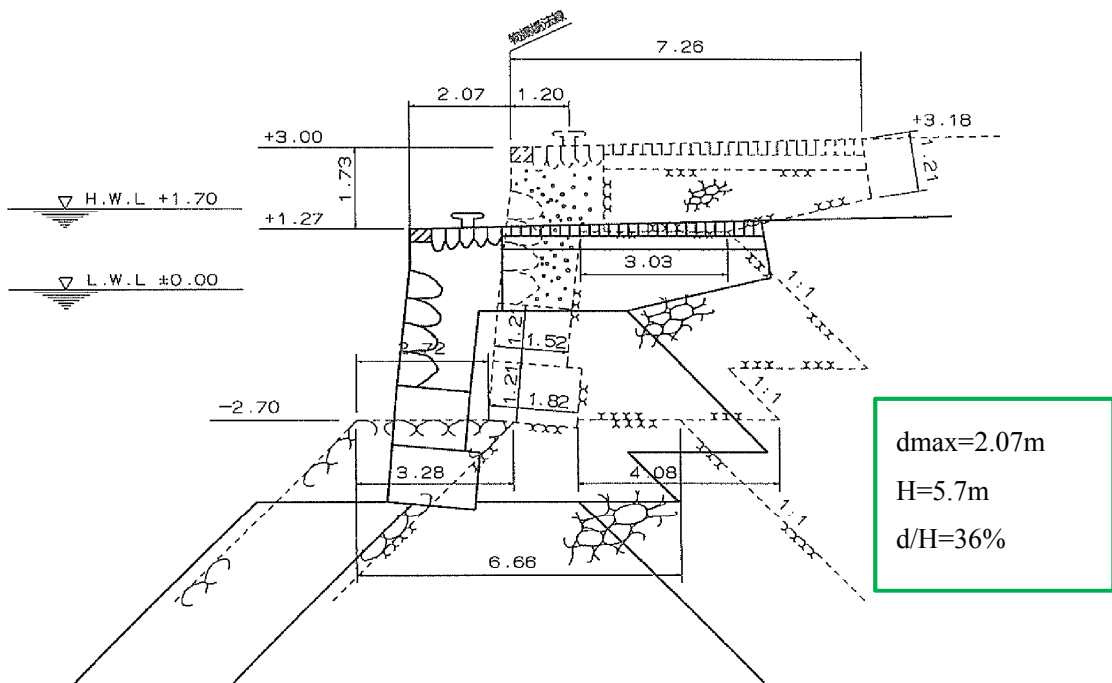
標準断面図, 被災状況断面図 (A-A) (新港西, ①1~2突堤間物揚場)
